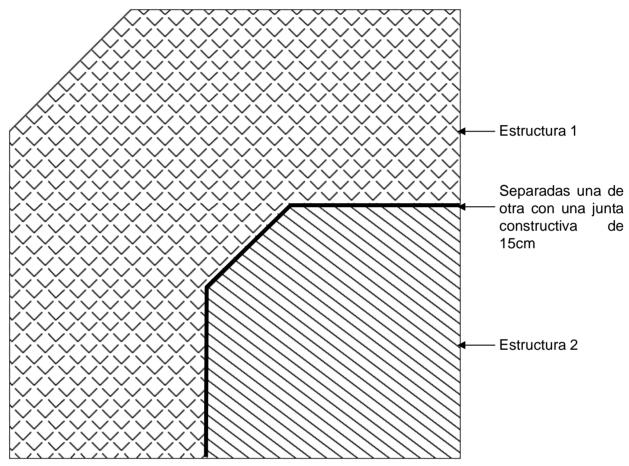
Esquema estructural de cimentación del proyecto. Elaboración propia.
